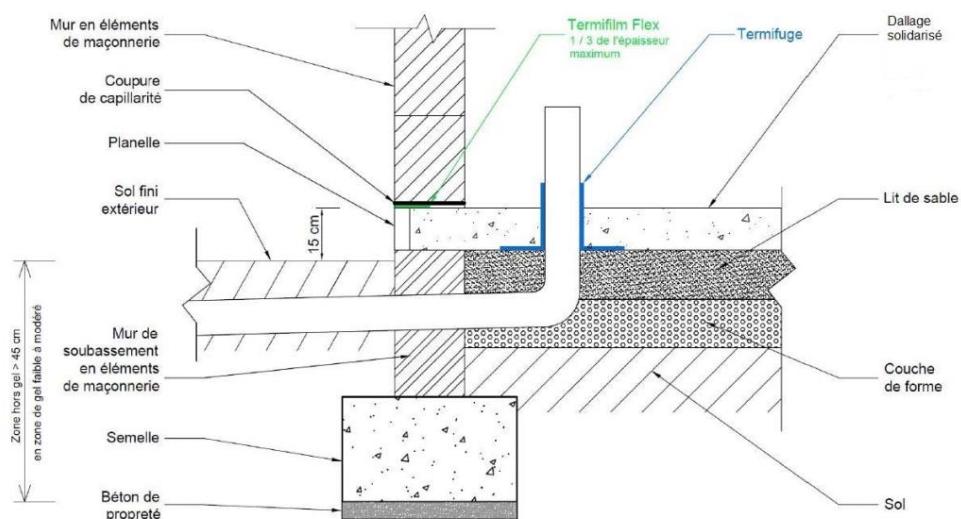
Protection des traversées de dallage solidarisé/dalle portée par application de TERMIFUGE (Disposition autorisée en zone sismique uniquement pour les maçonneries de plus de 30cm d'épaisseur)
